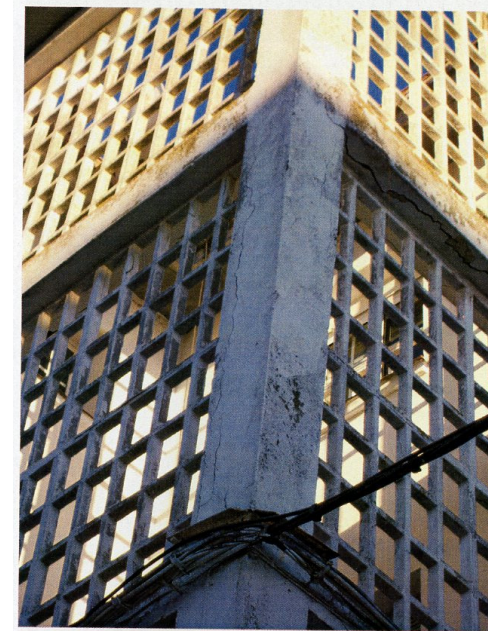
Grieta en viga y pilar de patio extremo
